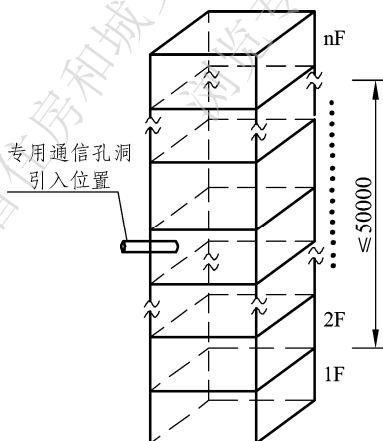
电梯井道设置通信孔洞位置示意图 (单位: mm)
